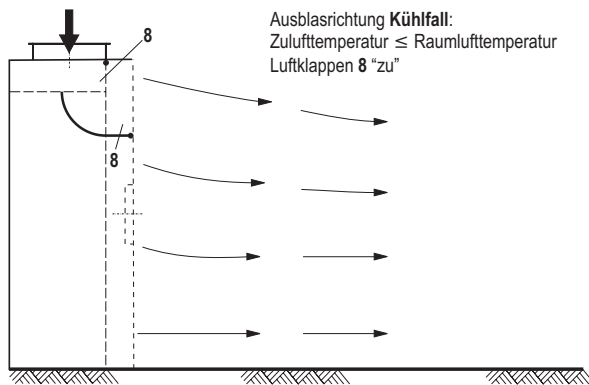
Rechteckiger Verdrängungsauslaß mit Verstelleinrichtung
